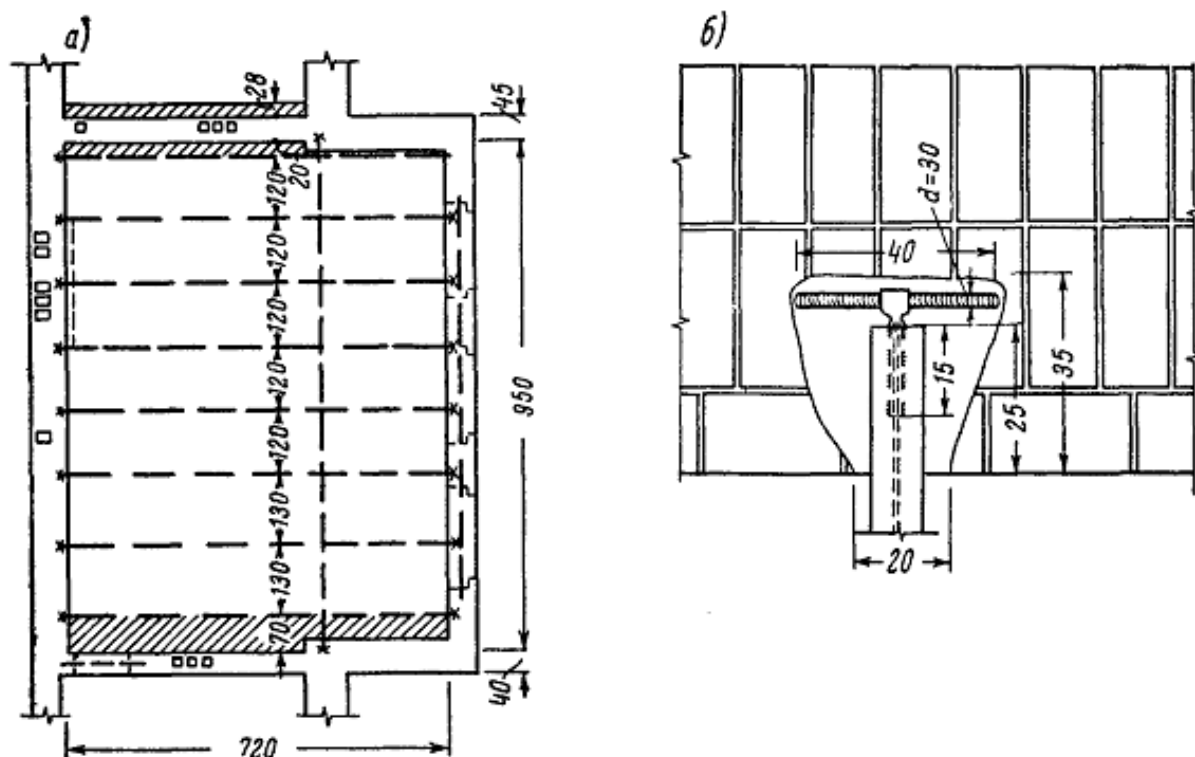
Перекрытие из стальных балок с заполнением плоскими железобетонными плитами
